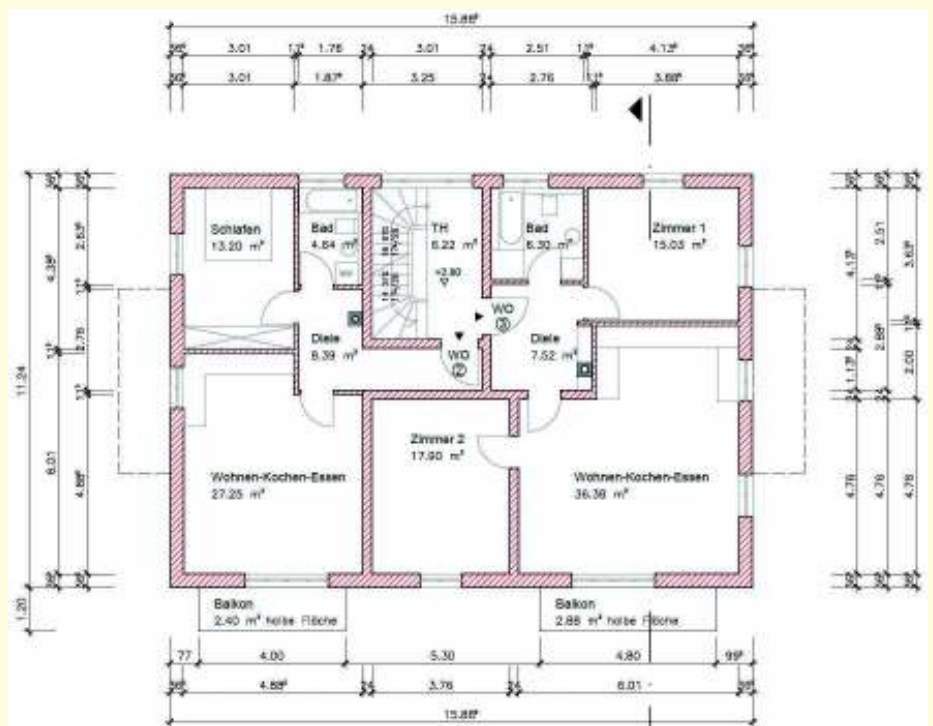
Grundriss Obergeschoss des Mehrfamilienhauses [6]
